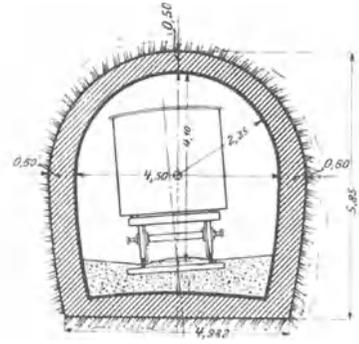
Eingleisiger Beton-tunnel der Hudson- und Manhattan-Röhrenbahn in Neuyork.
